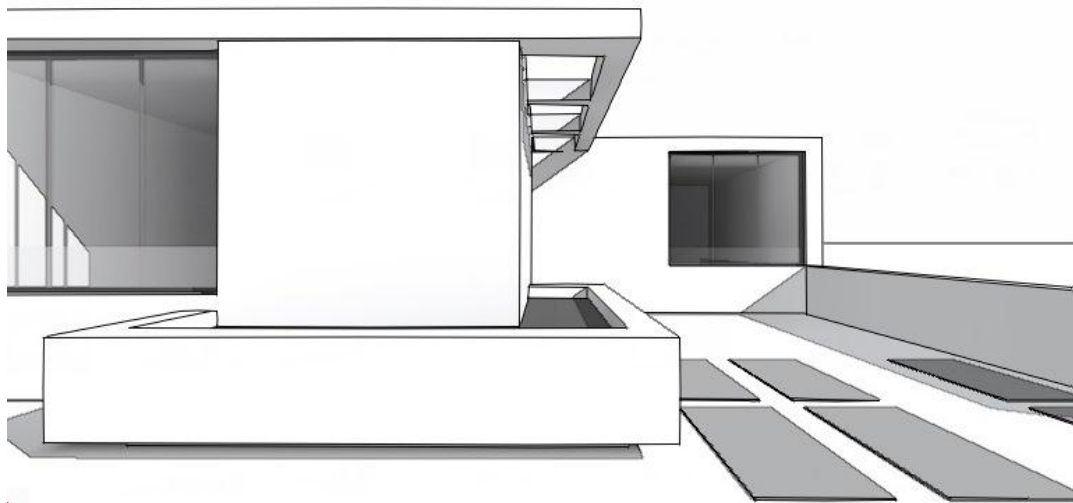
Vista 3d fachada. Fuente: Elaboración propia.
